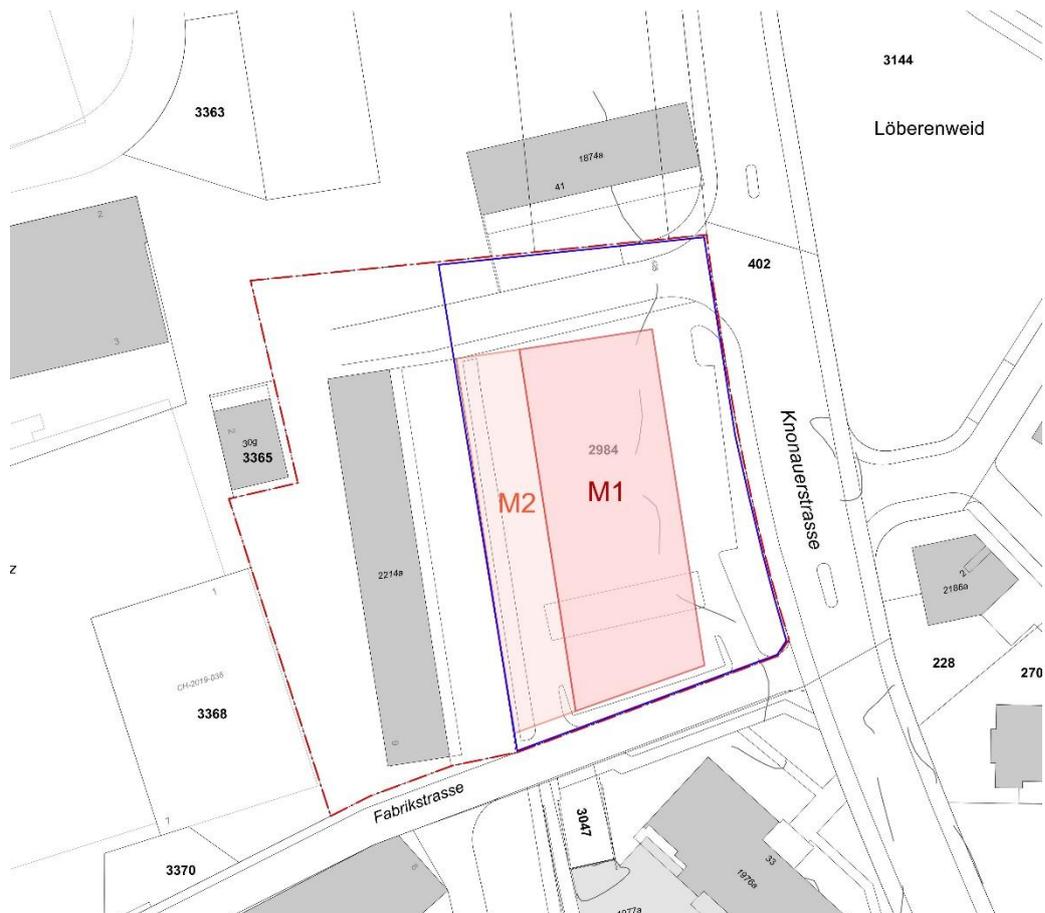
Projektperimeter (blaue Linie) und Baufelder (rote Flächen) auf dem Grundstück GS 2984 (rote gestrichelte Linie)
